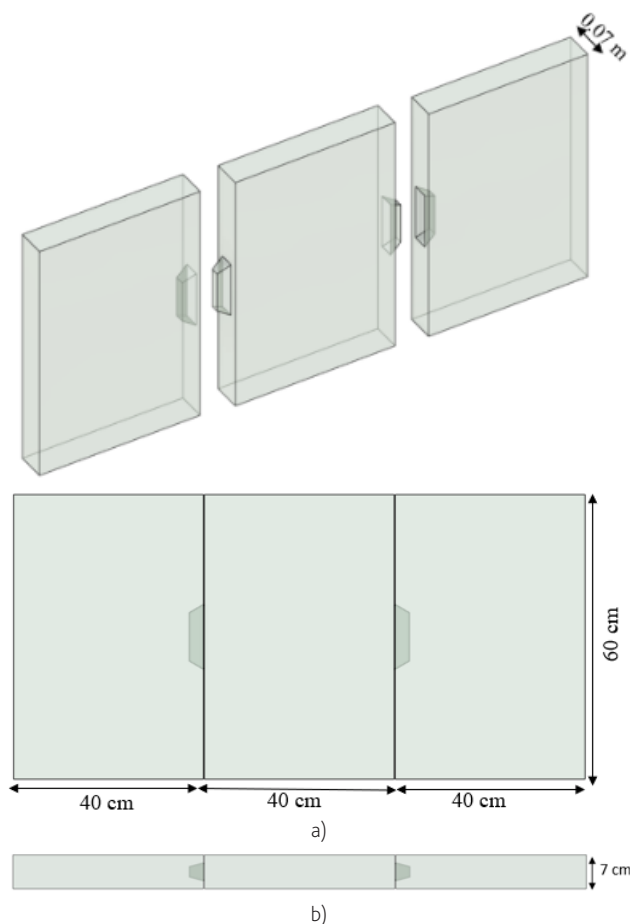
Dimensões dos provetes de ensaio: a) vista superior, b) vista frontal
